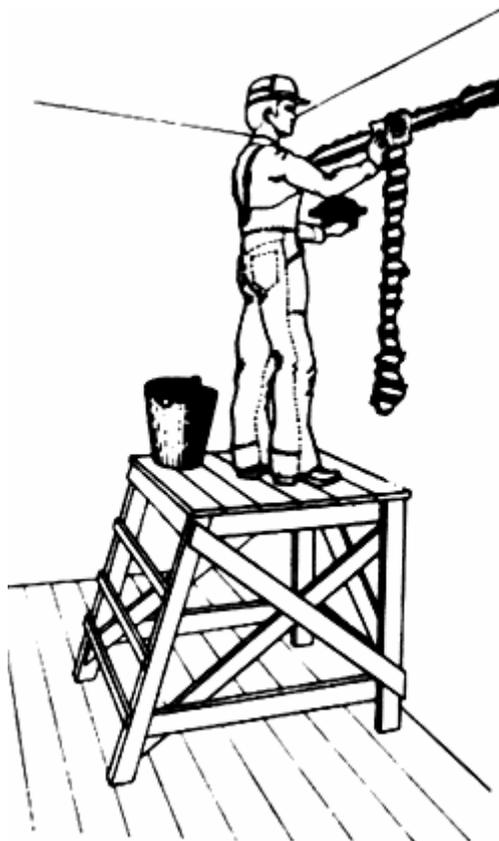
Установка и крепление соединительных коробок и деталей крепления под приборы
